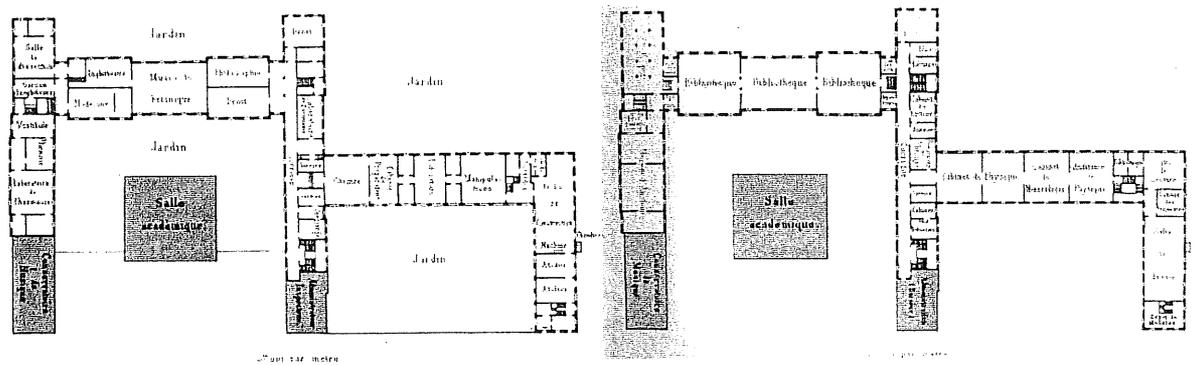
Plan de l'Université sur deux niveaux en 1869
